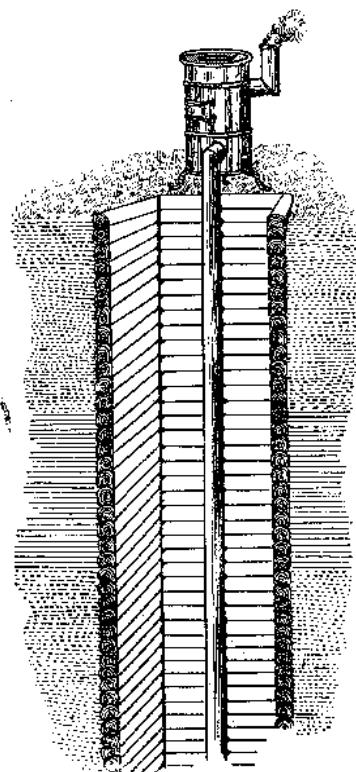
Установка чугунной печи для вентиляції (вытгиванія испорченного воздуха).
